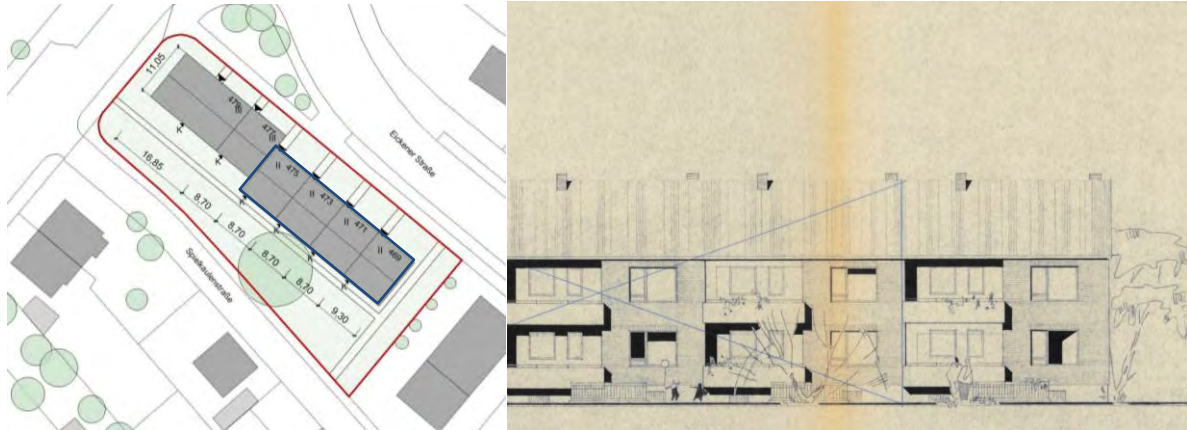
Lageplan und Straßenansicht. Quelle: Eigene Darstellung / Ansicht Originalplan
